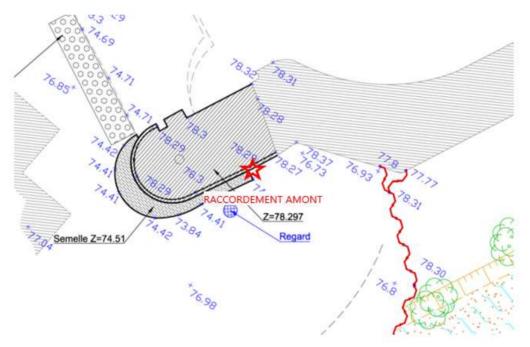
Raccordement du rideau de palplanches amont en rive droite
